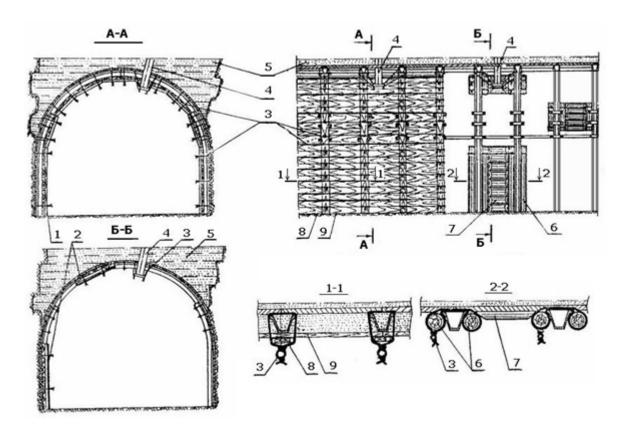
Конструкция деревянной опалубки Условные обозначения: 1 – опалубка сплошная; 2 – опалубка местная; 3 – скрутка из проволоки, диаметром 5-6 мм; 4 – труба контрольная; 5 – бетон; 6 – опора затяжки дополнительной; 7 – затяжка дополнительная; 8 – доска 120х40; 9 – доска, толщиной 20-40 мм
